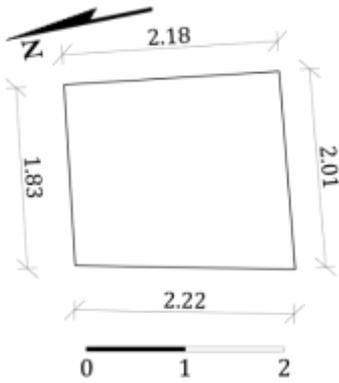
مسقط أفقي للمنور بهليلز
